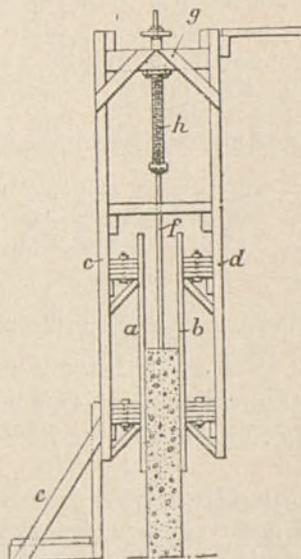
Detalle de las formas móviles para la construcción de los depósitos circulares de hormigón armado.
